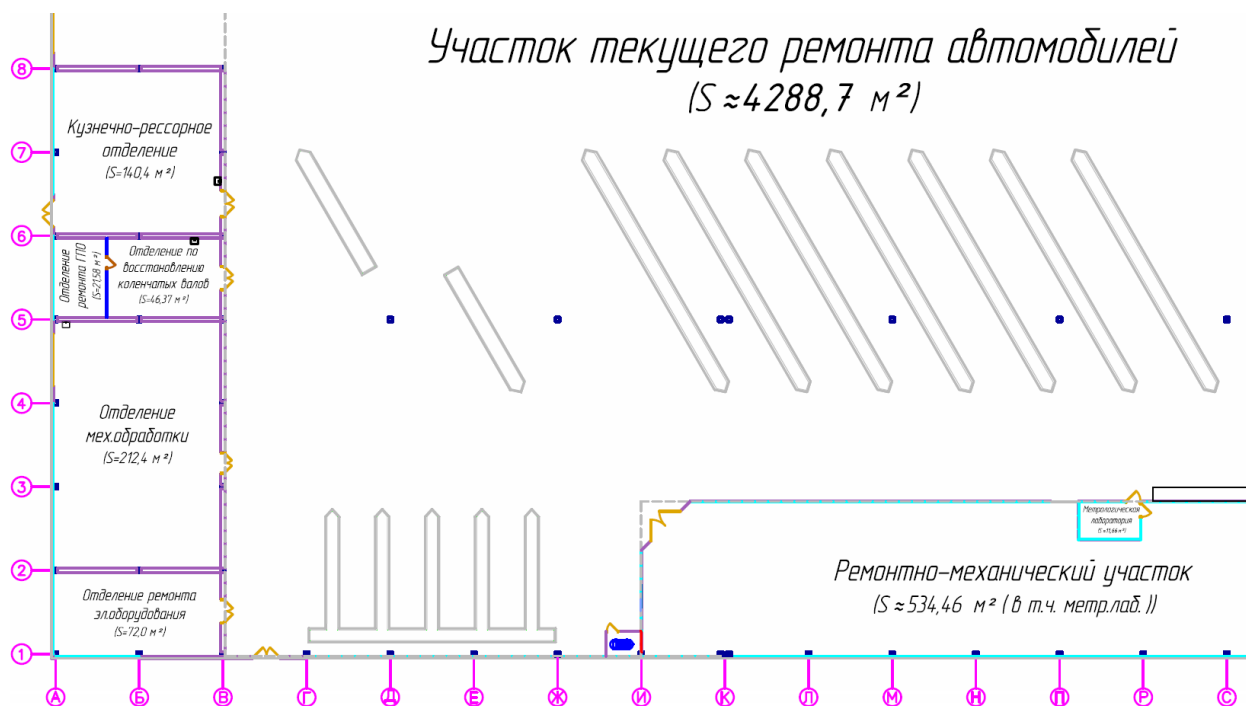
Фрагмент схемы АРМ после перепланировки.
